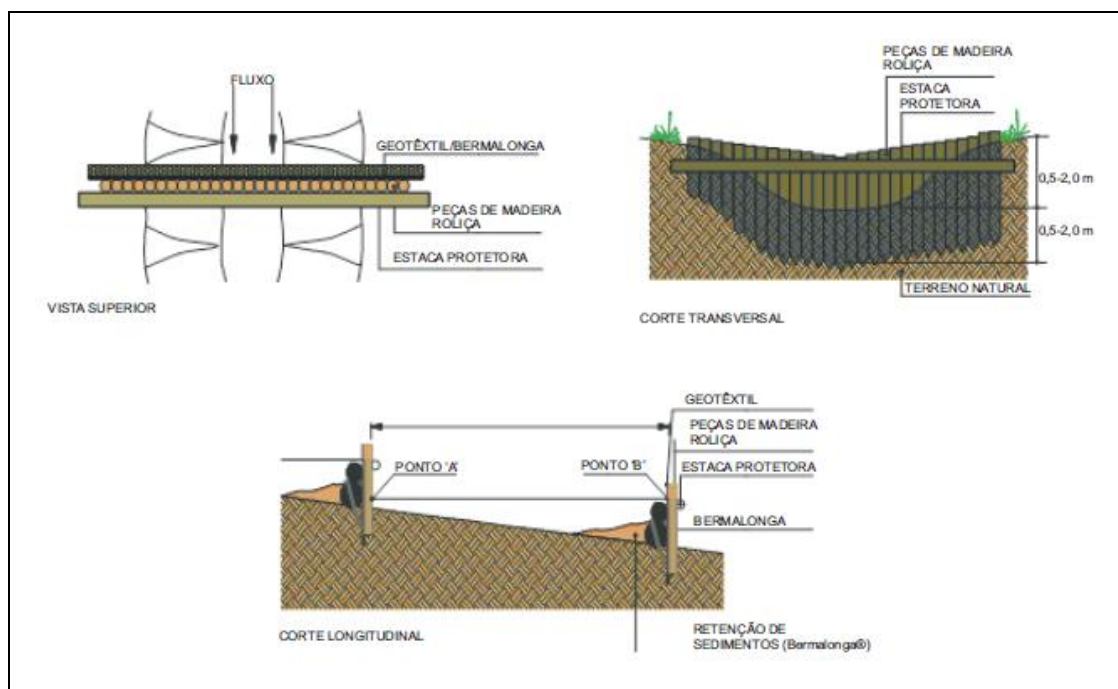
Visada em planta e corte da construção de paliçadas de madeira.
